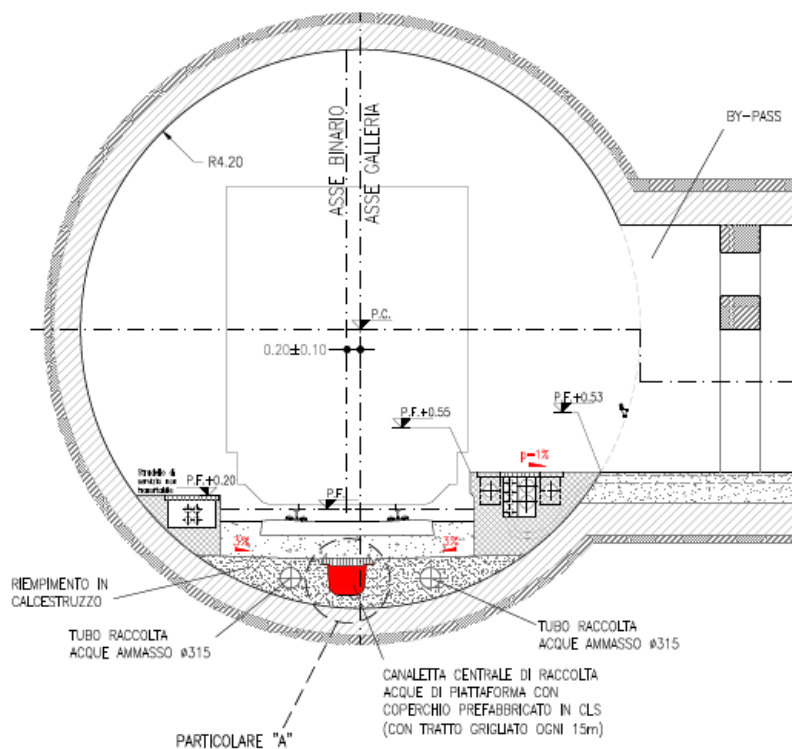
Sezione trasversale tratta in meccanizzato – Collettamento acque piattaforma – Corrispondenza bypass
